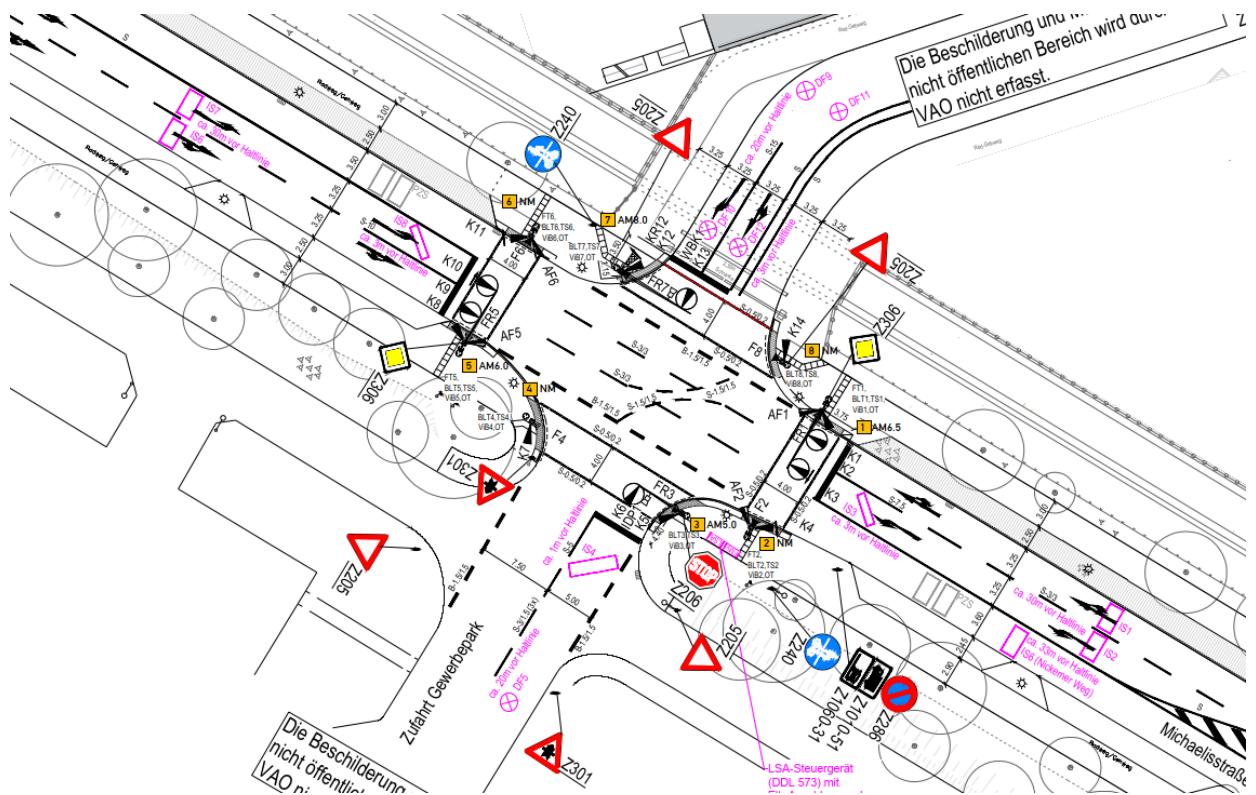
Signallageplan KP4 – Michaelisstraße / Zufahrt Möbelmärkte – Zufahrt Kaufpark
